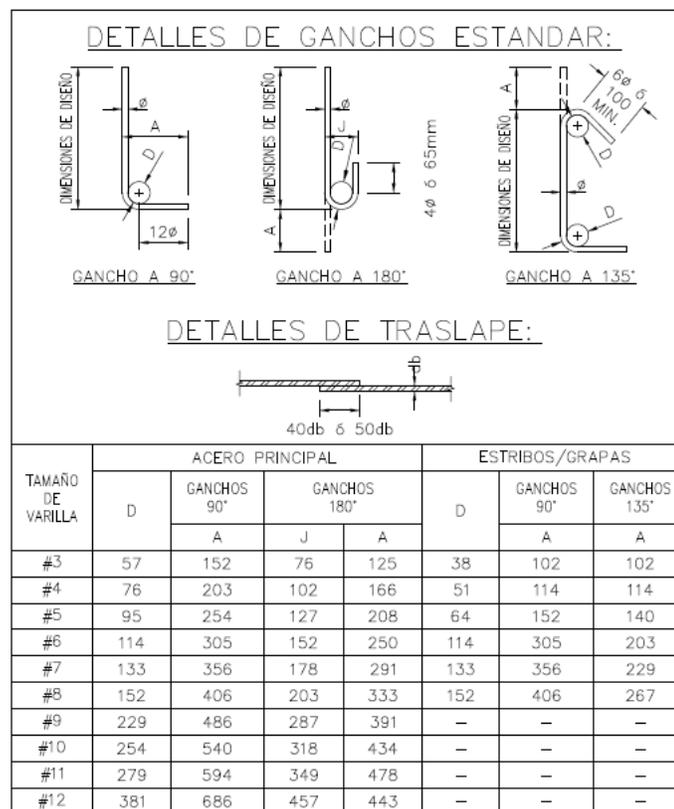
Detalles para habilitado del acero de refuerzo (varilla)
